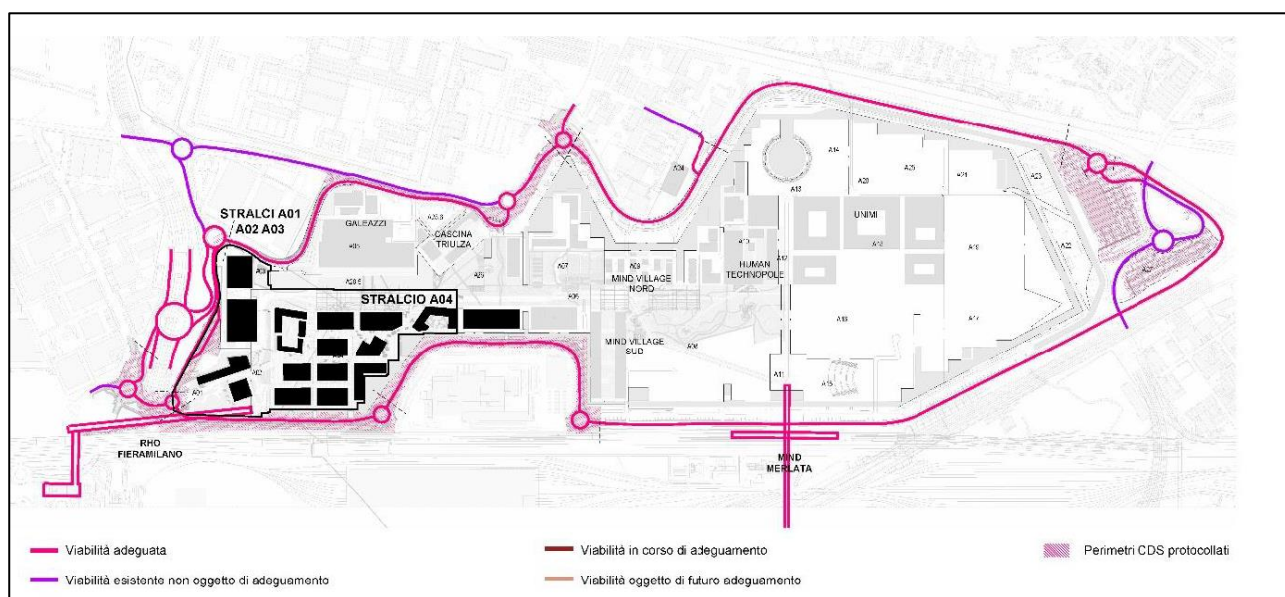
Planimetria di MIND all'orizzonte T6 (fonte STUDIO MIND)
